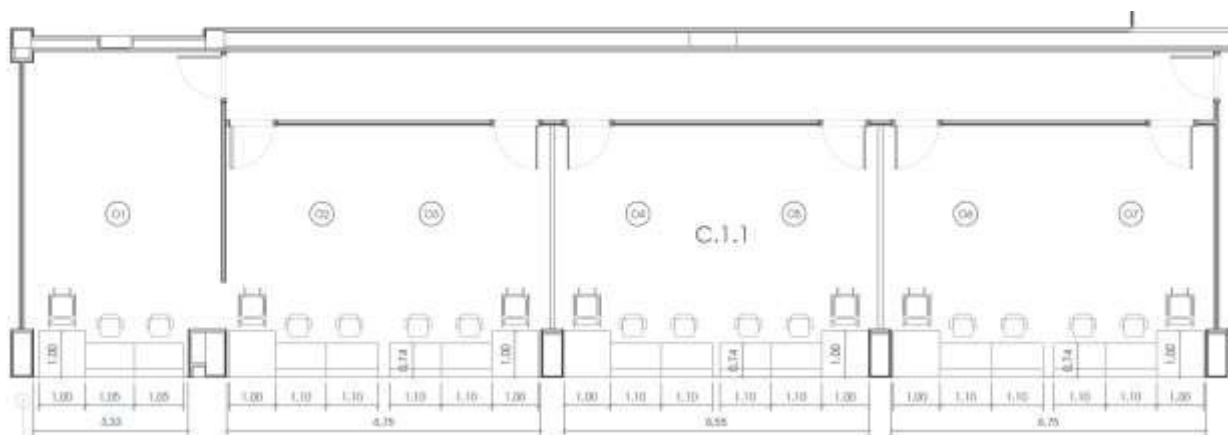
Propuesta en planta de la distribución de los mostradores
